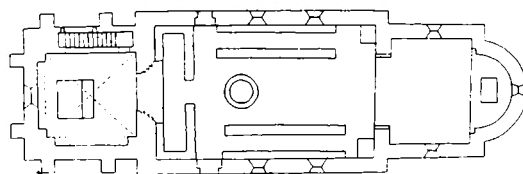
Rekonstruktion af kirkens indretning o. 1320. Plan 1:400.
